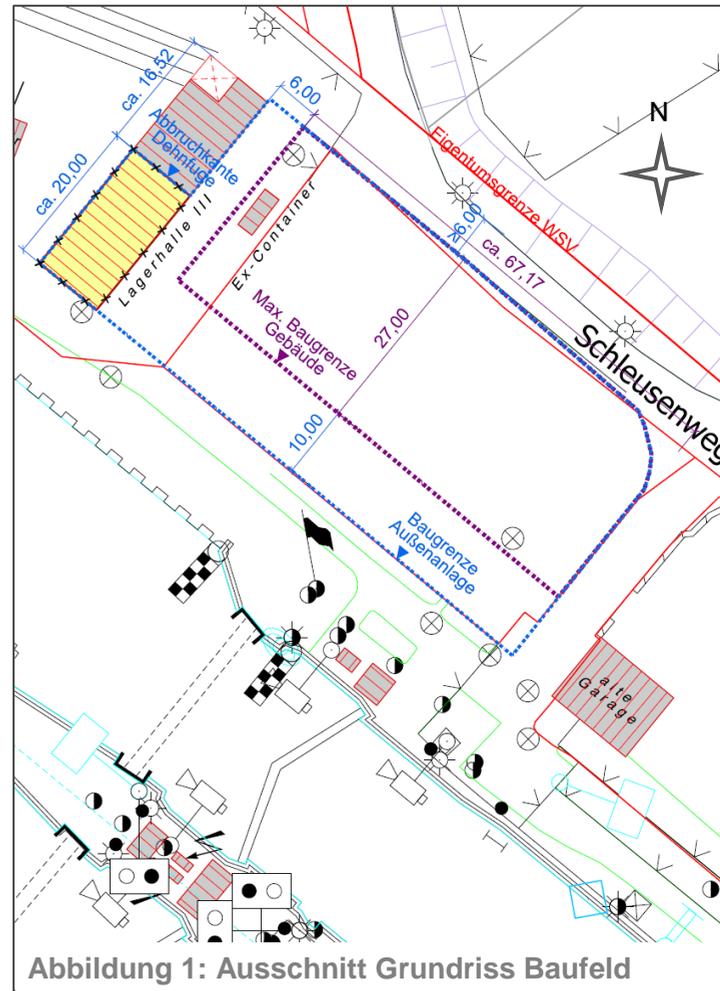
Ausschnitt Grundriss Baufeld
